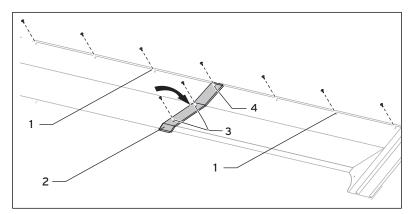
Atornillar las planchas del tejado y colocar los empalmes superiores de la plancha del tejado
